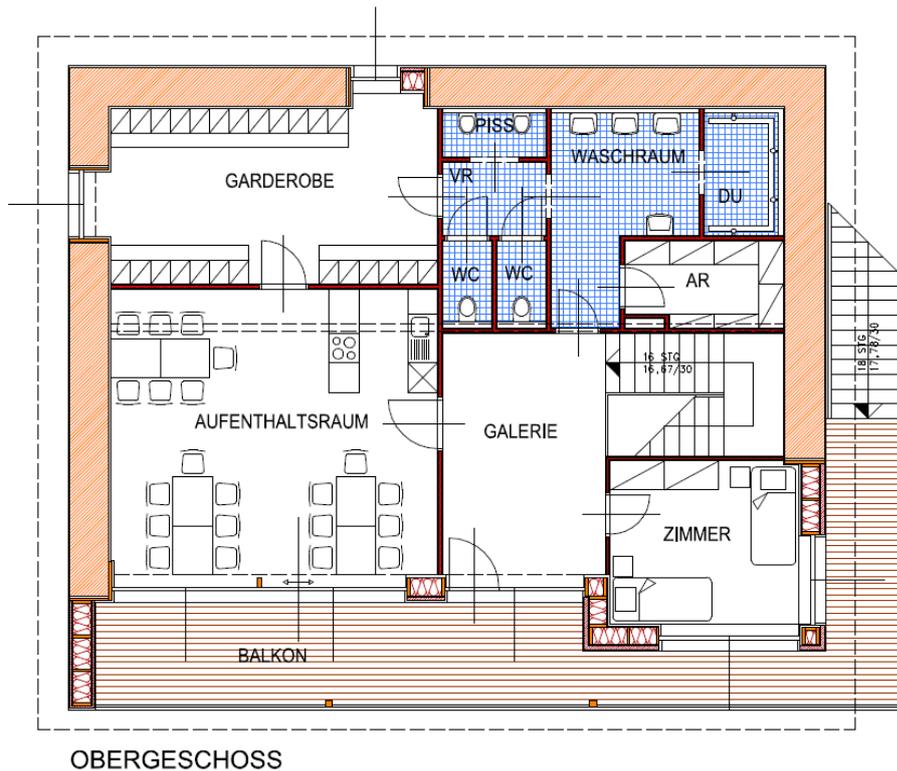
Grundriss des Obergeschoßes des Musterhauses aus lasttragender Strohballenbauweise, Baumeister Jürgen Höller (Quelle: Baumeister Ing. Jürgen Höller GmbH)
